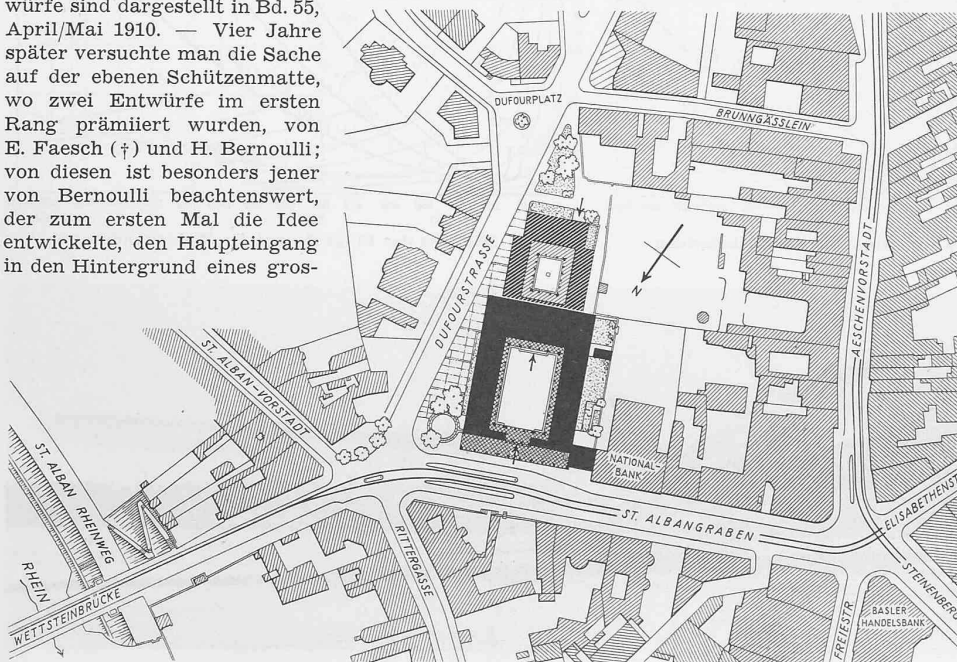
Lageplan 1:3000 des Basler Kunstmuseums und seiner stadtbaulichen Situation.
